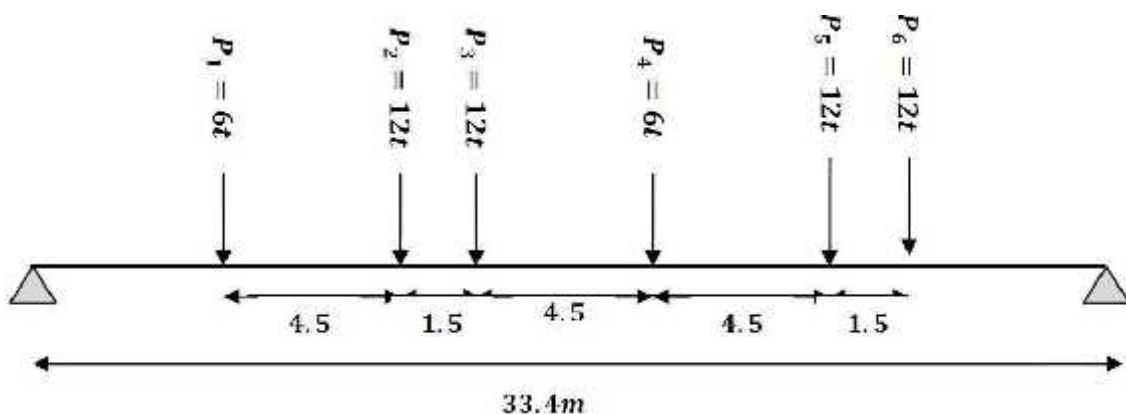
Système B_c disposition de deux camions sur la chaussée (sens longitudinal)
